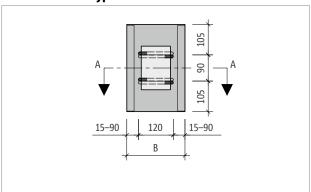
Schöck Sconnex® type W-N-VH : projection horizontale du produit ; positionnement des barres d'effort tranchant
